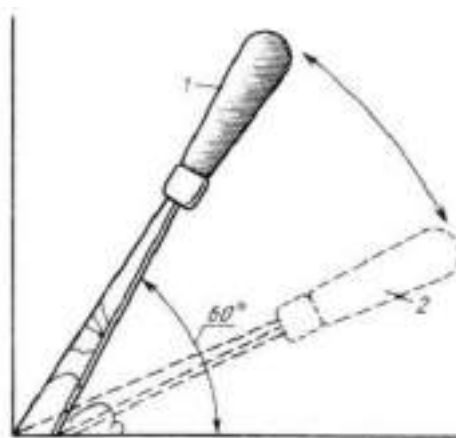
Положение шпателя при шпатлевании: 1 - хорошо; 2 - плохо
